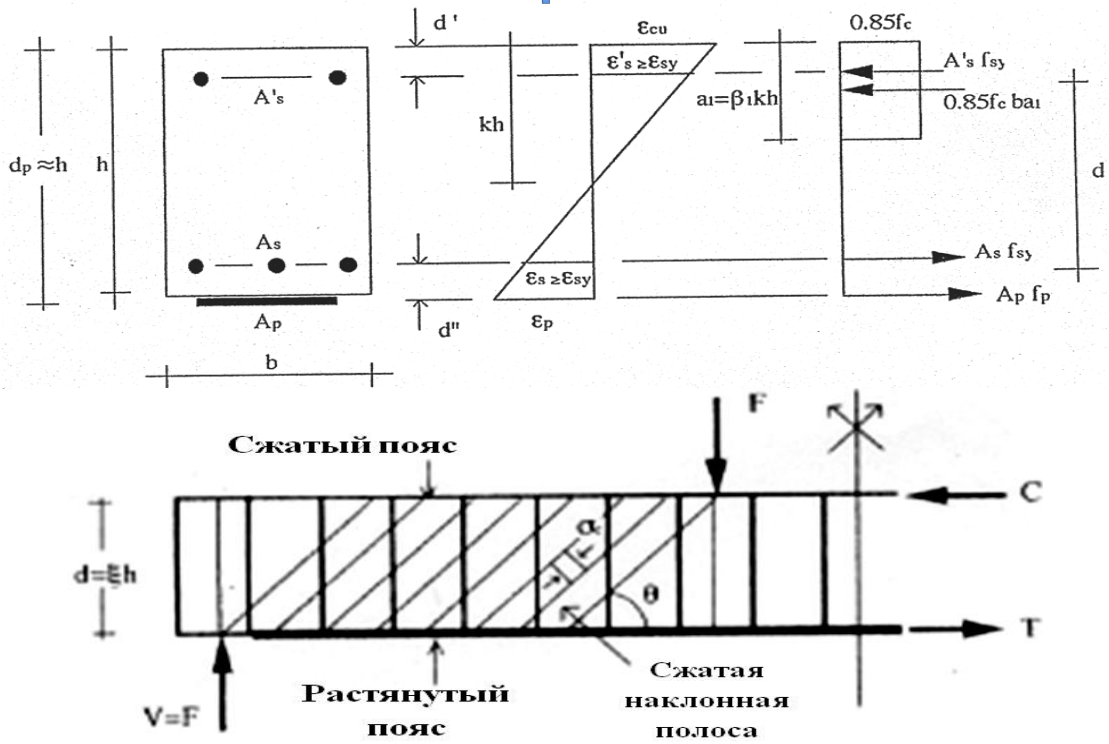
Расчётная схема для усиленного элемента при расчёте по методу аналоговой фермы
